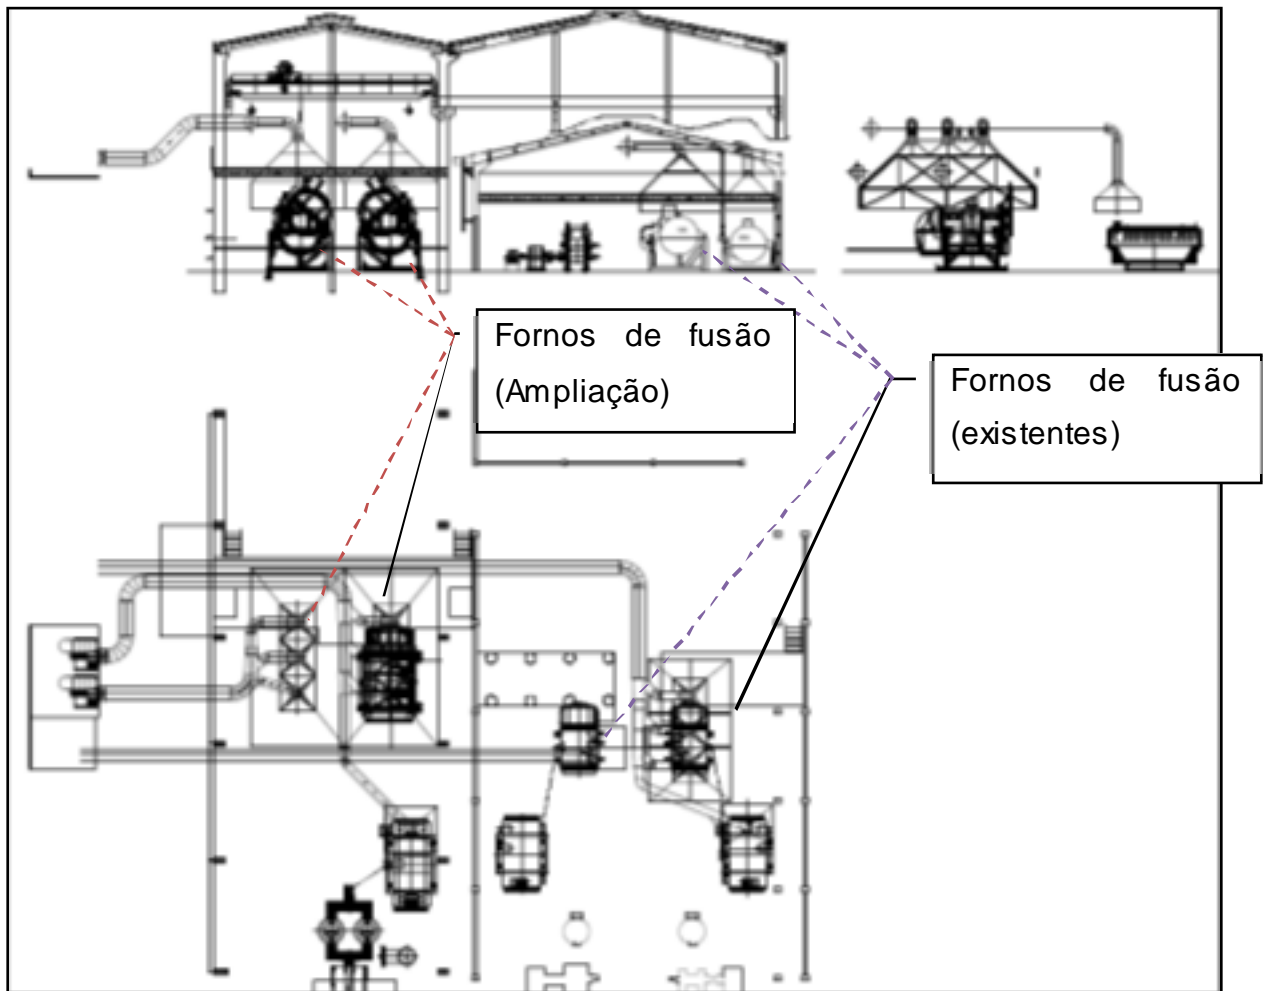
Layout de instalação (Planta, Elevação e Vista Lateral Esquerda).
